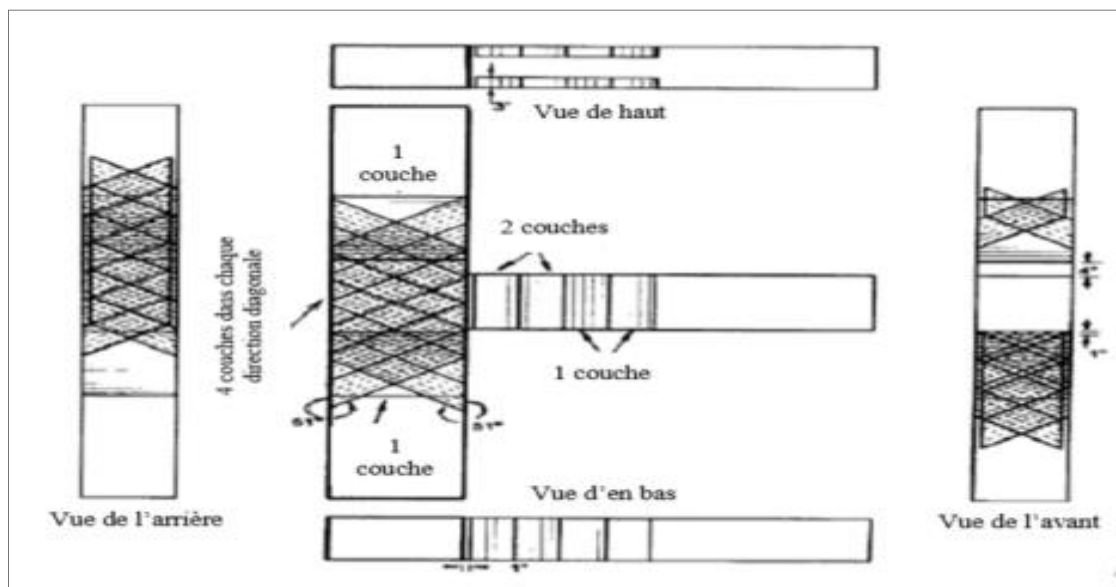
Plan du renforcement du composite de (Pantelais et al) [47].
